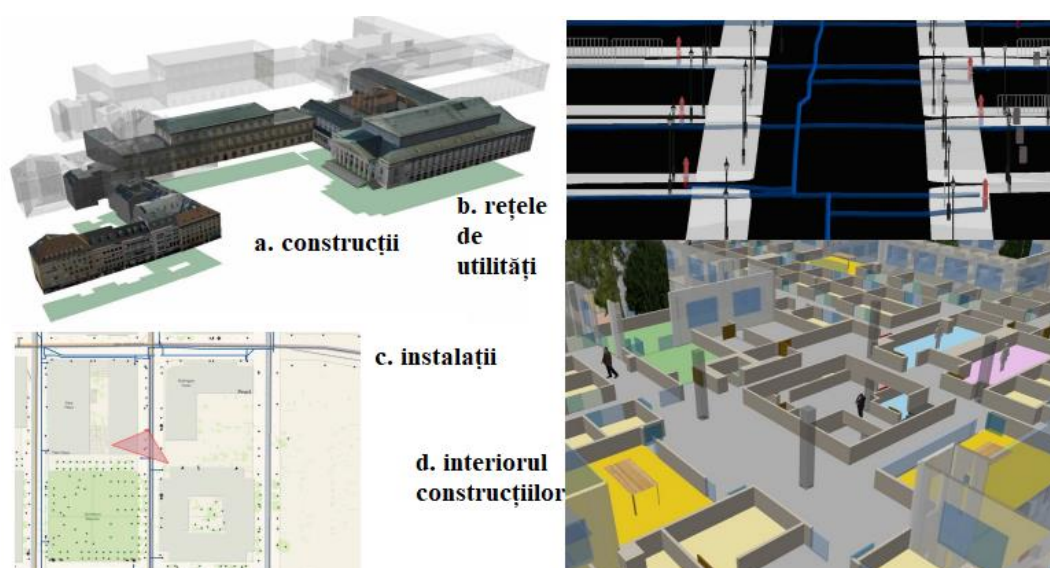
Mediul construit în 3DCIM (Reitz et al., 2014)
